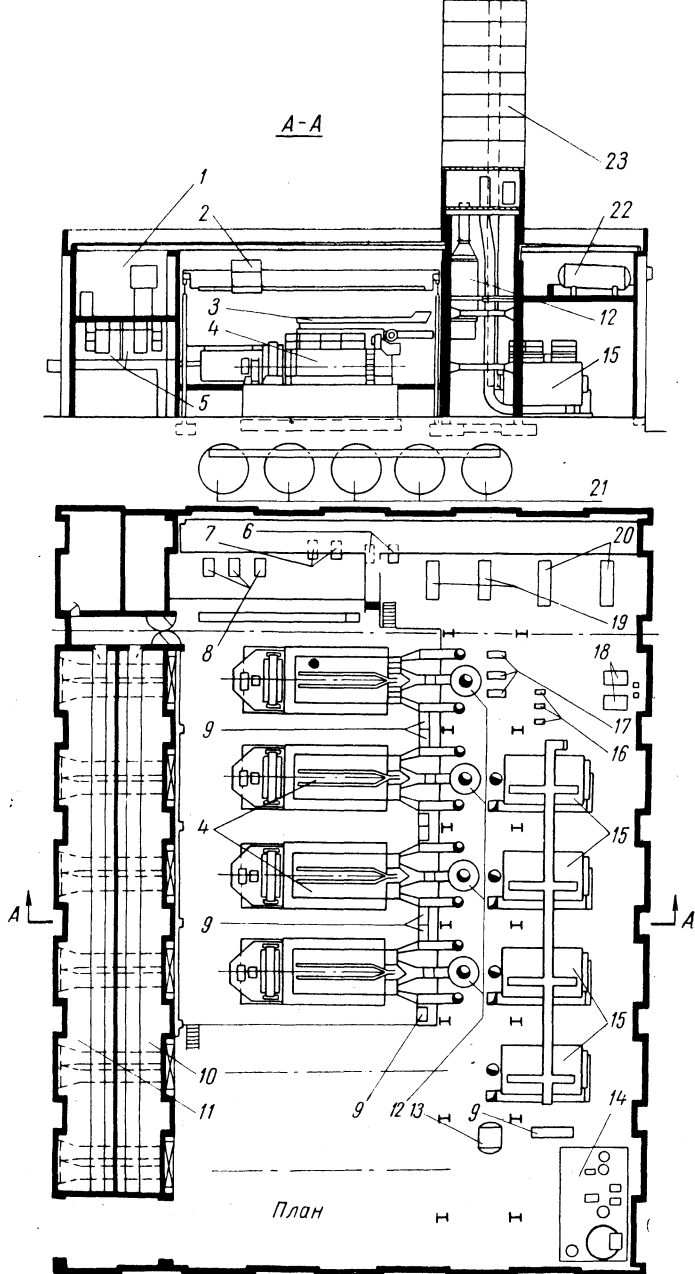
Поперечный разрез и план стационарной теплосиловой установки
